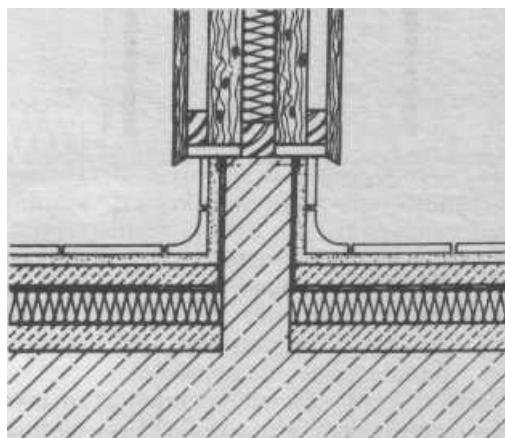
Правильная конструкция легкой внутренней стены во влажном помещении
